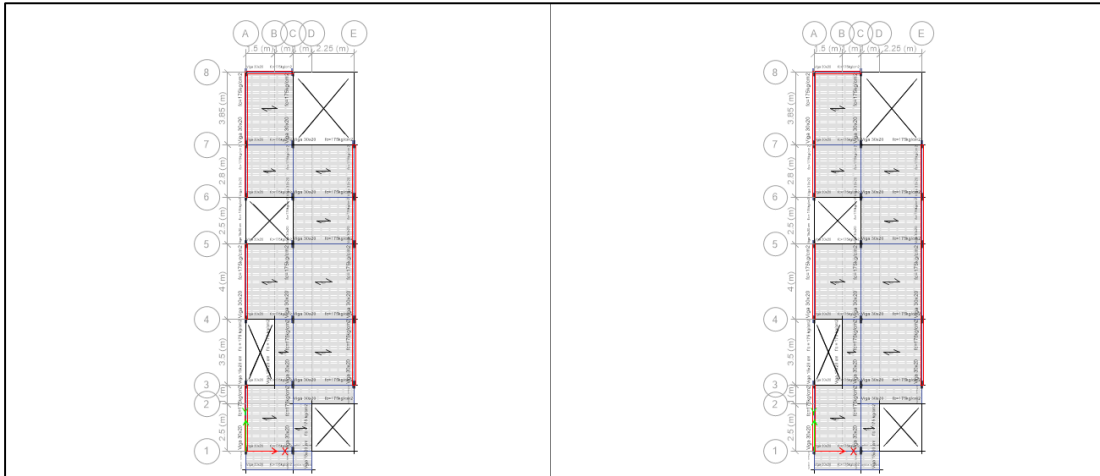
Modelo estructural de la situación actual de la vivienda 1– Vista en planta de losa del primer y segundo nivel. Fuente: propia.
